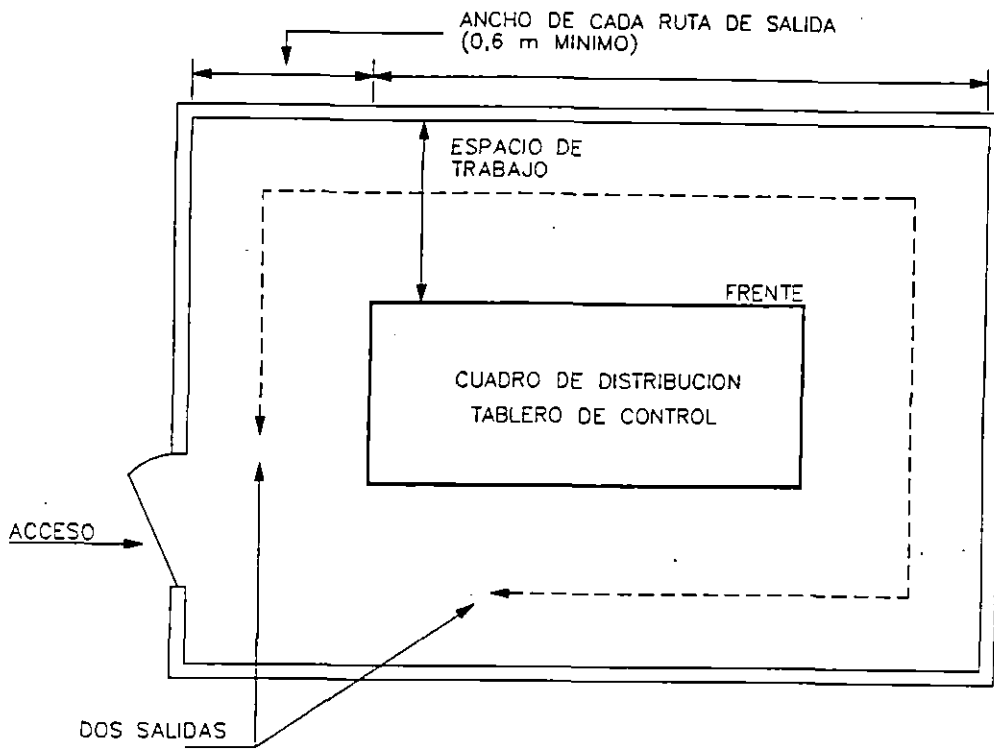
Caso en donde sólo se requiere una puerta de acceso.
